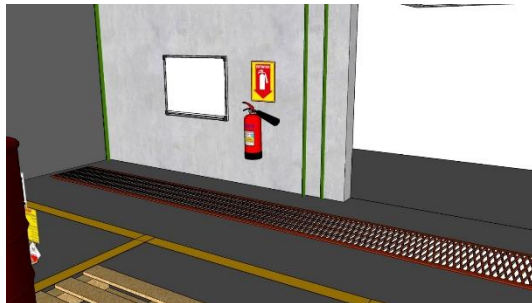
Tampak Samping Kanan Bangunan TPS Limbah B3
